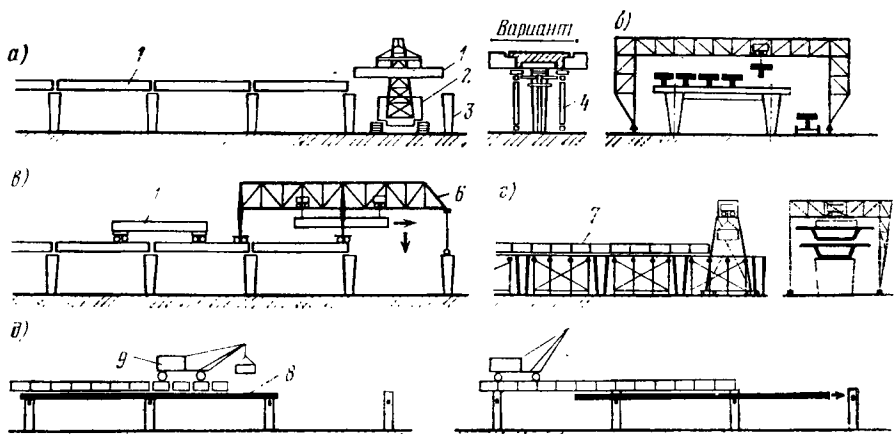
Схемы монтажа пролетных строений из цельнопролетных балок и блоков на подмостях:
